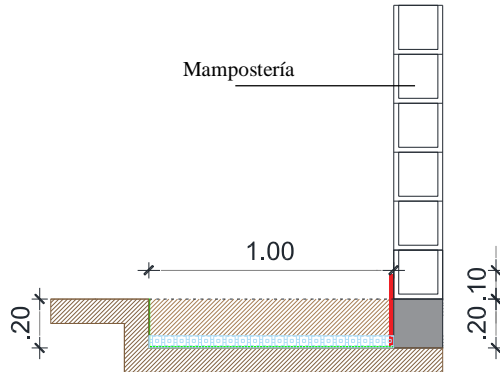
Detalle de relleno y compactación de Tierra en Cadena (S/E)
